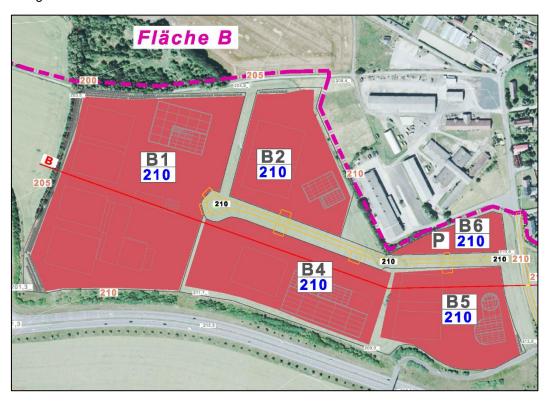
geplante Profilierung Fläche B (Original im Anhang)
